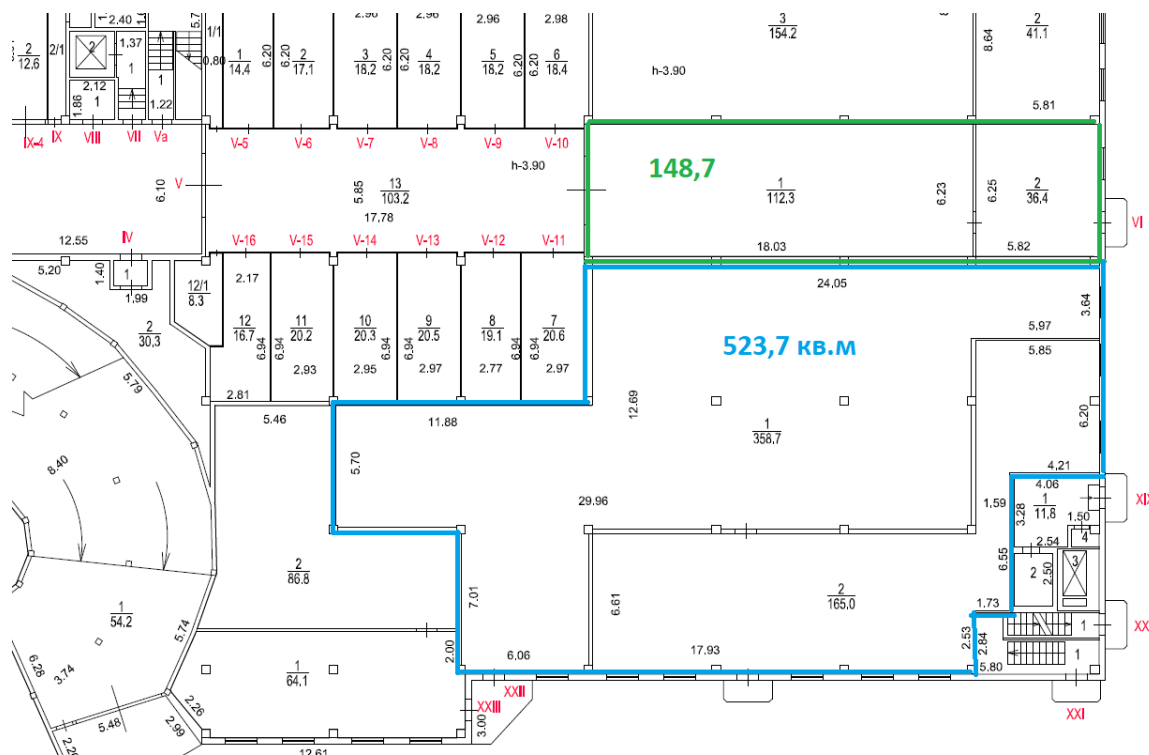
Схема оцениваемых помещений на плане этажа №1
